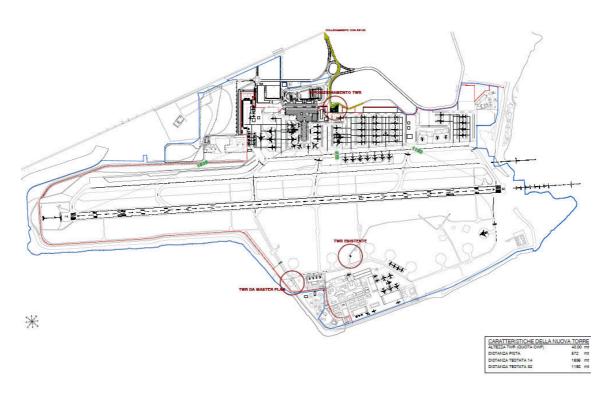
Planimetria generale dell'area aeroportuale con indicazione della posizione originaria prevista per la Torre di Controllo nel MasterPlan approvato e la proposta di variante localizzativa
